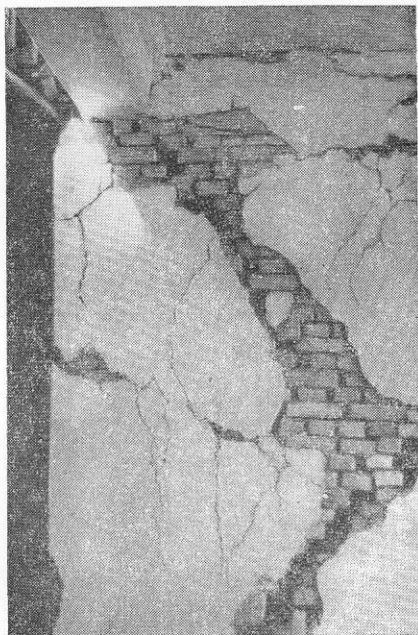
Внутренний входящий угол в лестничной клетке раскололся под нагрузкой от железобетонного прогона
